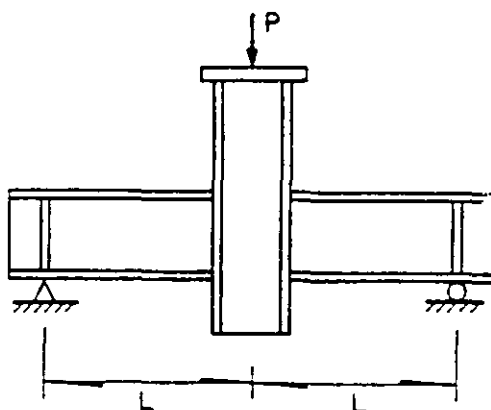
Conexiones con fuerzas cortantes elevadas en las vigas
